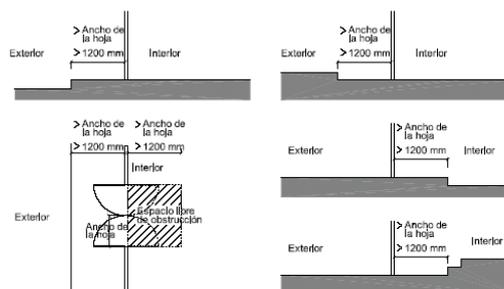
Distancia entre la puerta de acceso y el escalón más próximo
